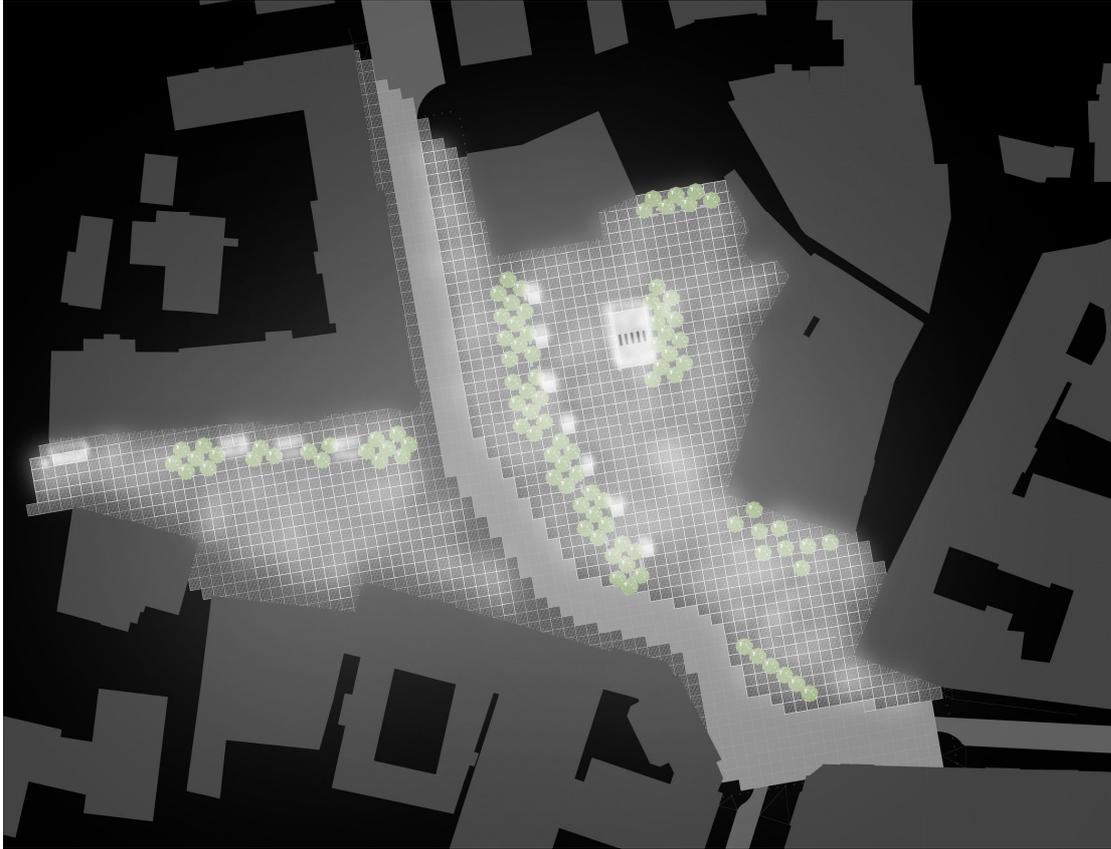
Grundriss bei Nacht<sup>161</sup>
